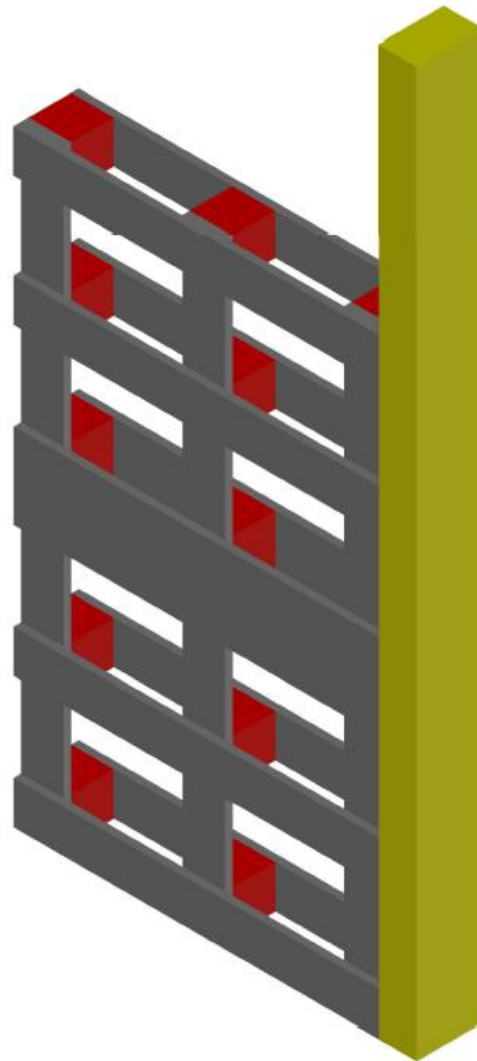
Viga de confinamiento proyecto I-BEAM
